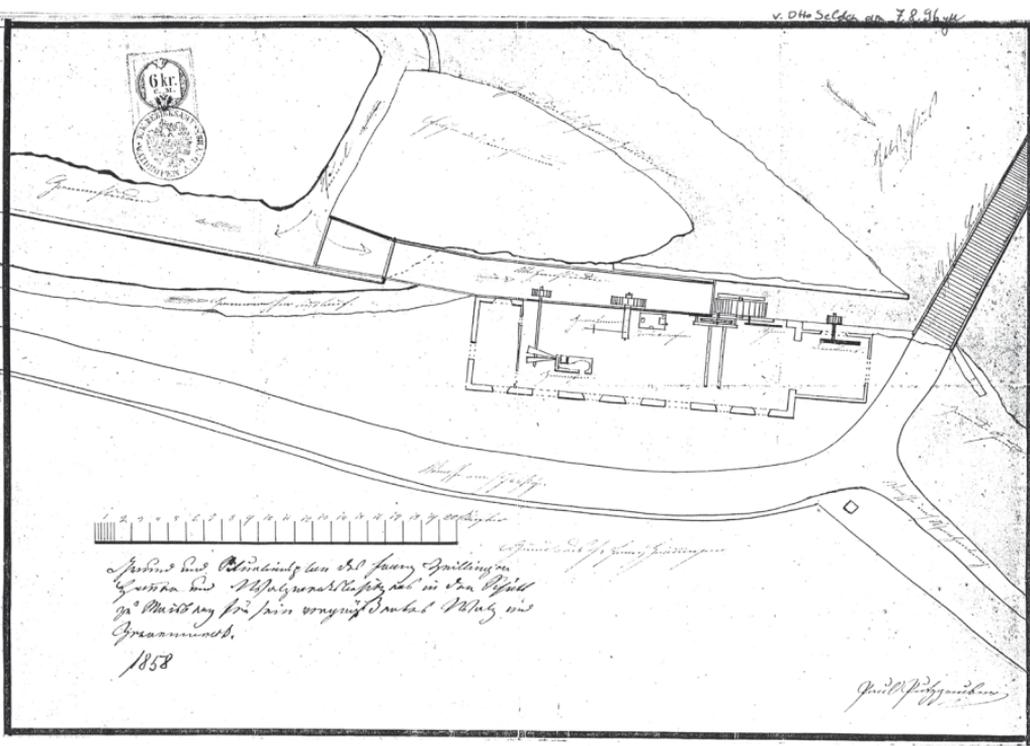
Das Walzwerk von Franz Zeillinger 1858. Norden rechts-unten.
